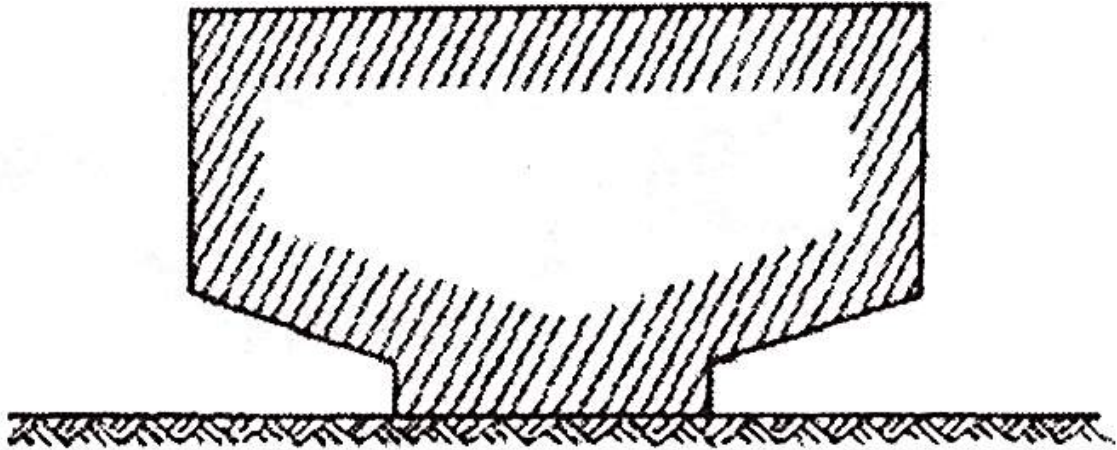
Esquema de una obra descansando en un apoyo.
